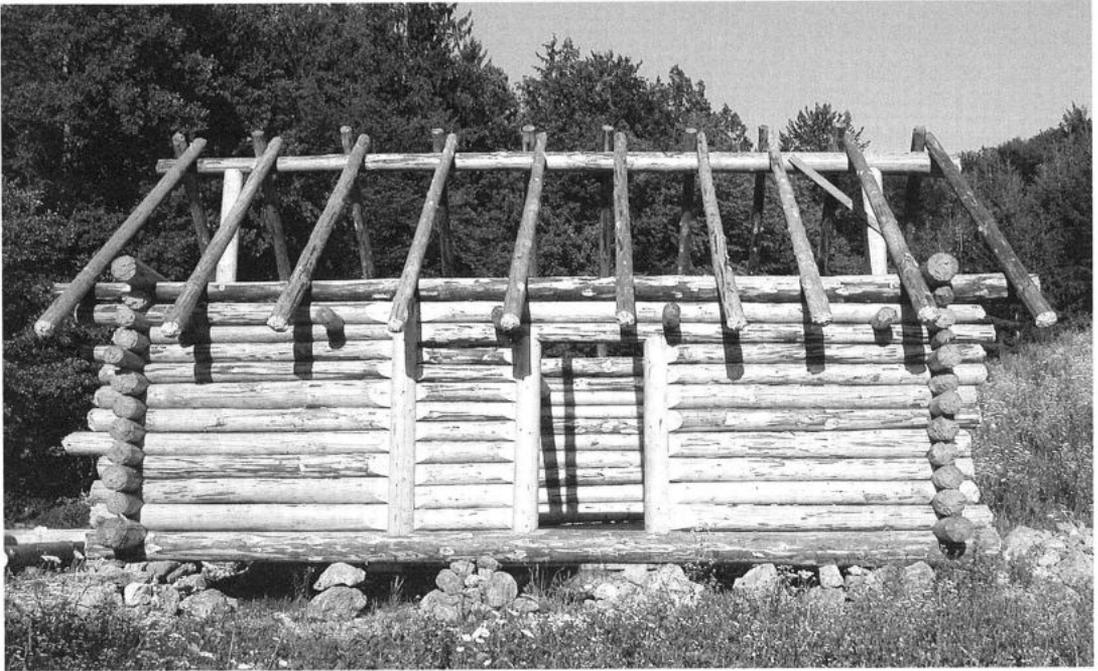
Rekonstruktion des Wohnhauses in Blockkonstruktion im Rohbau mit Firstpfette und Rofendach.
